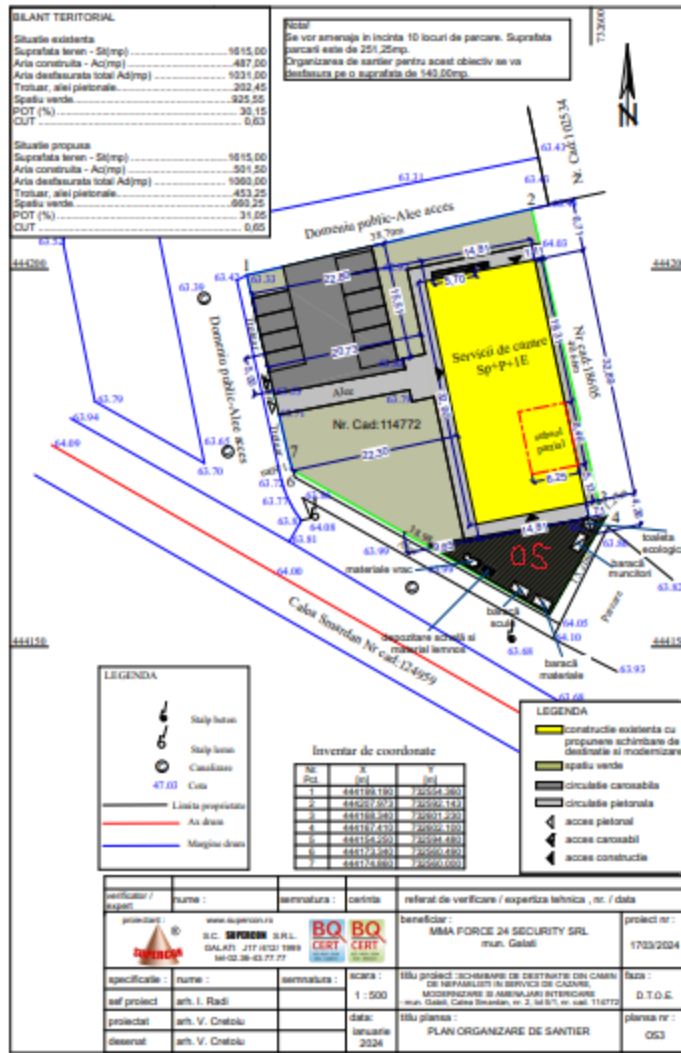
Plan Organizare de santier, plansa OS3, proiect nr.1703.20224 faza DTOE
